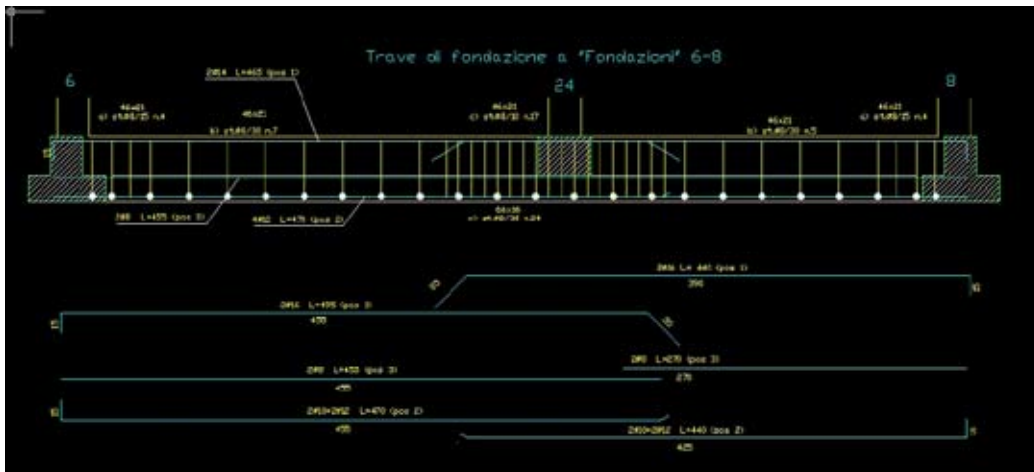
Armatura longitudinale della fondazione con soluzione intelaiata in c.a.
